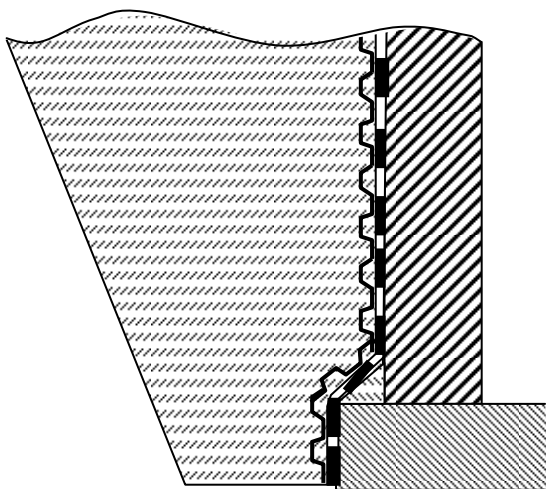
Coupe de mise en œuvre étanchéité + DRAINAX (cas où le drainage n'est pas obligatoire, ou le remblai est drainant si le drainage est obligatoire)
